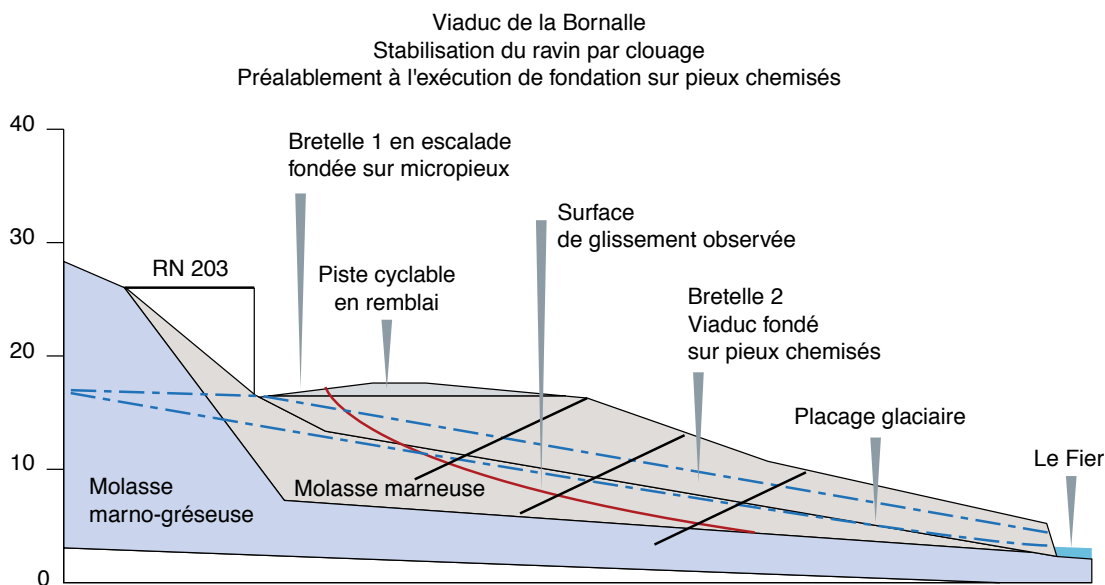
Glissement de La Bornalle (Haute Savoie, 74)
